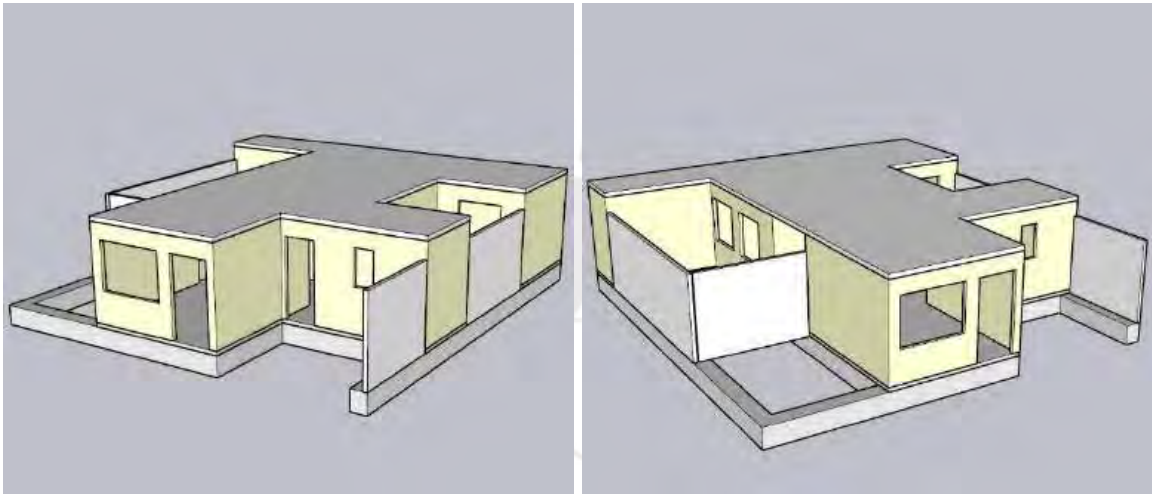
Modelado 3D - Casa San Agustín – Encofrado de Aluminio
